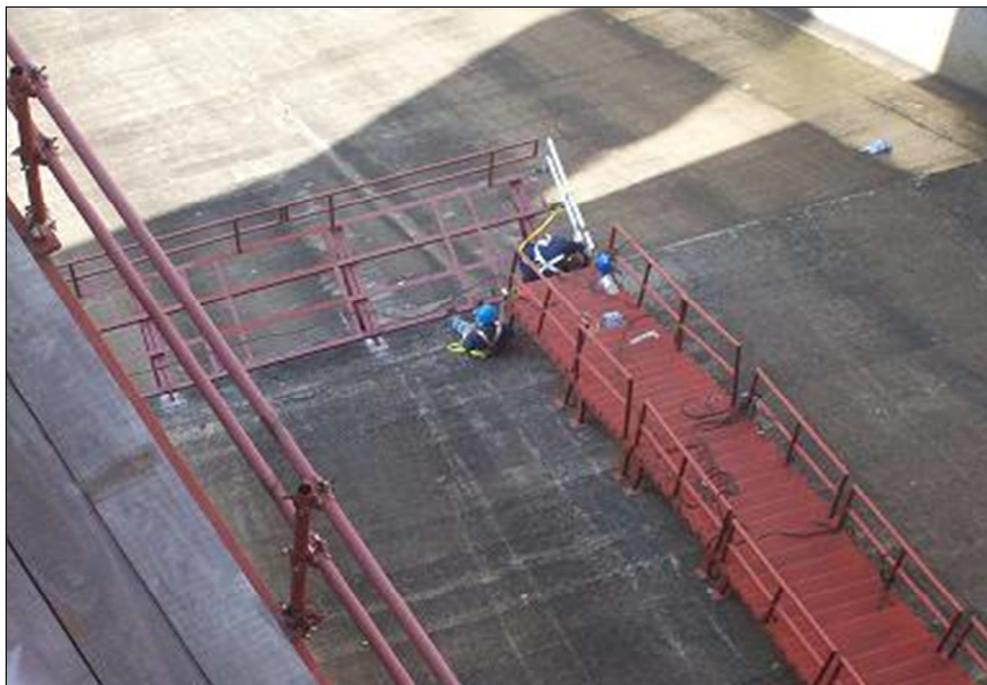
Colocación de estructuras de acceso al canal 1 del aliviadero.
